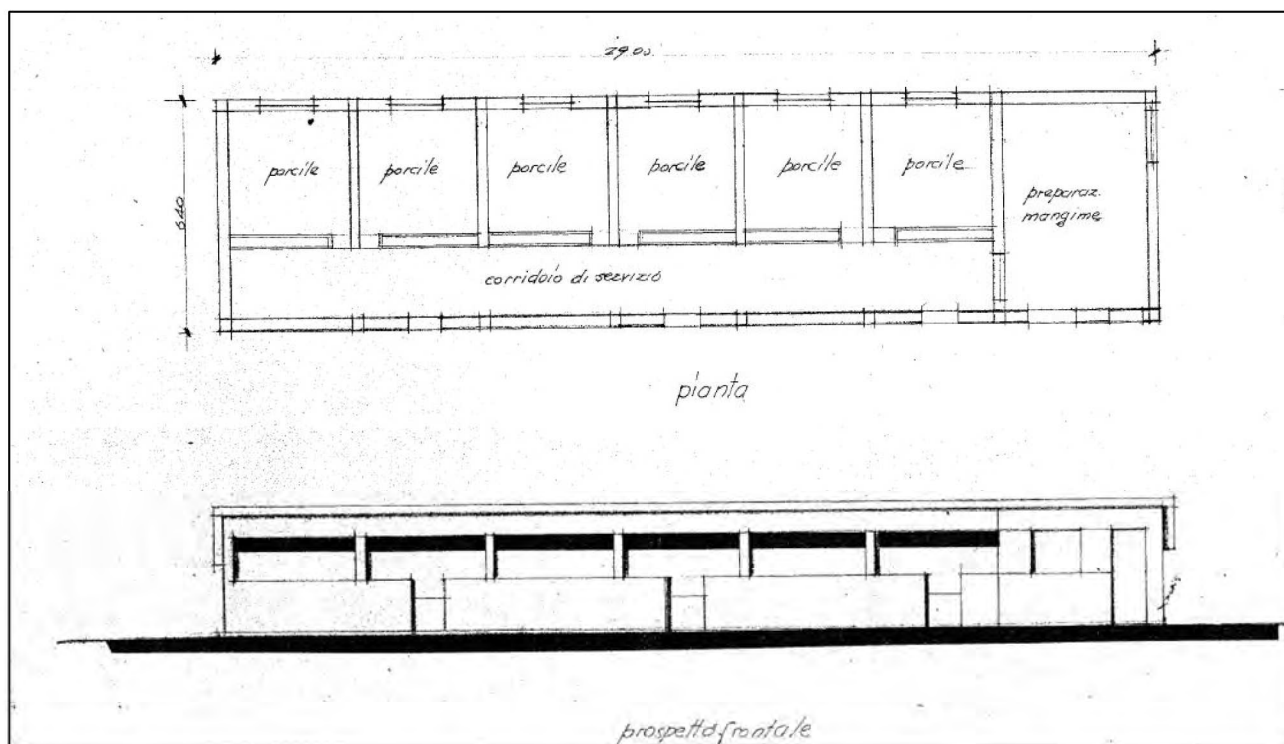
Planimetria e prospetto frontale stalla - Licenza a costruire in variante n. 24bis del 18.07.1973
